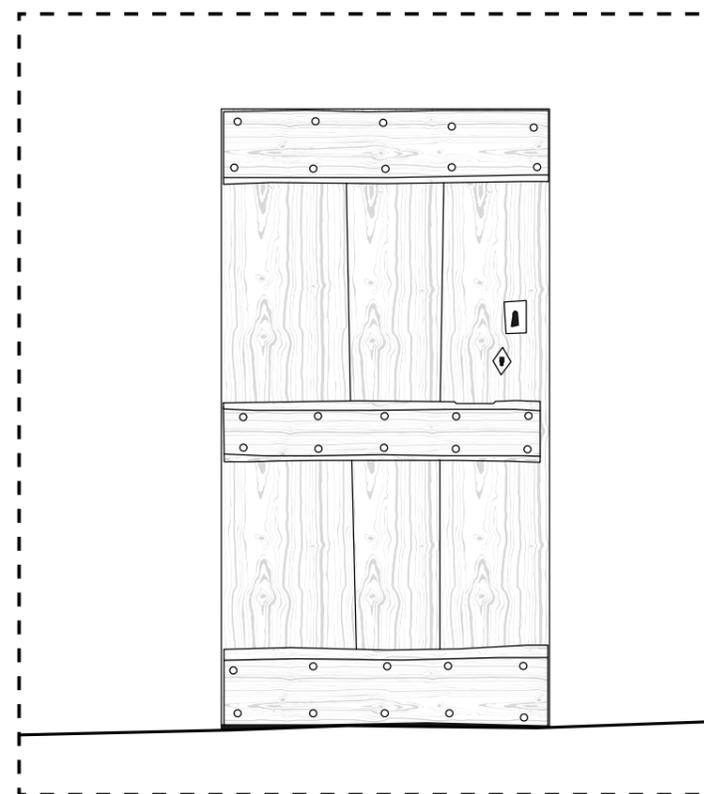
Ridisegno (fuori scala) della tipologia di porta in legno a anta singola, edificio n.8, prospetto Sud.
